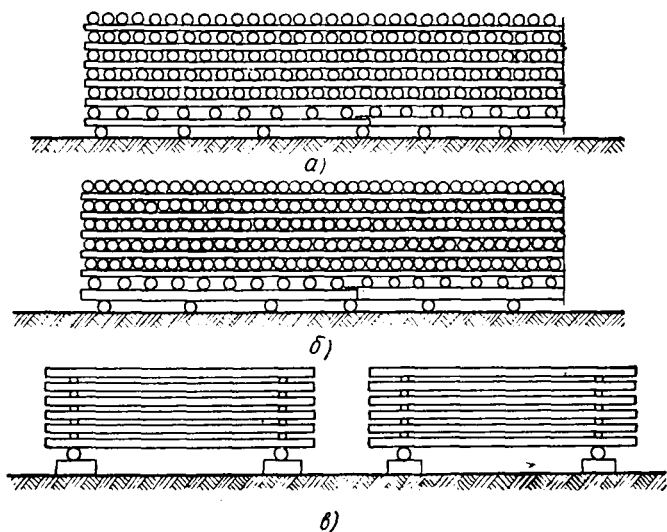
Способы укладки круглых лесоматериалов при хранении в штабелях:
